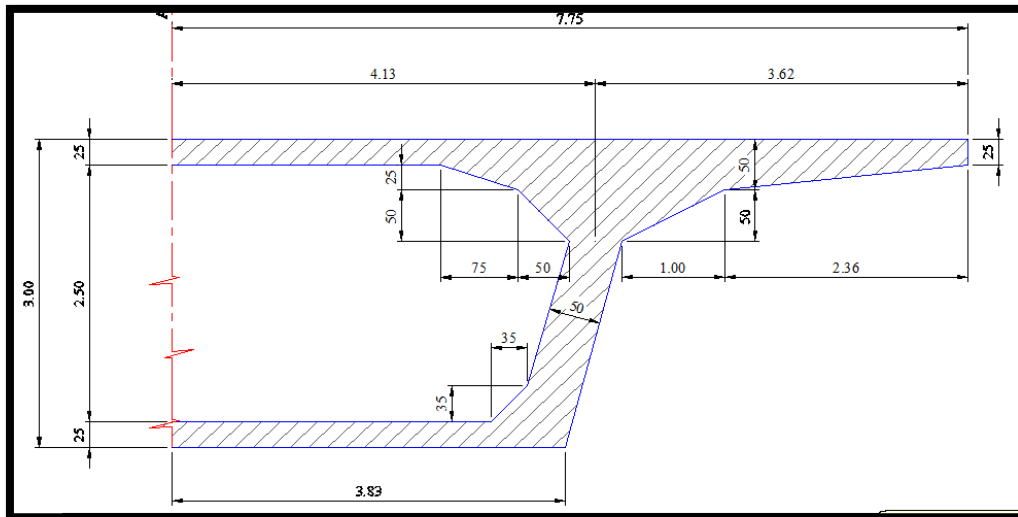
Détail demi-coupe du voussoir au niveau de la clef
